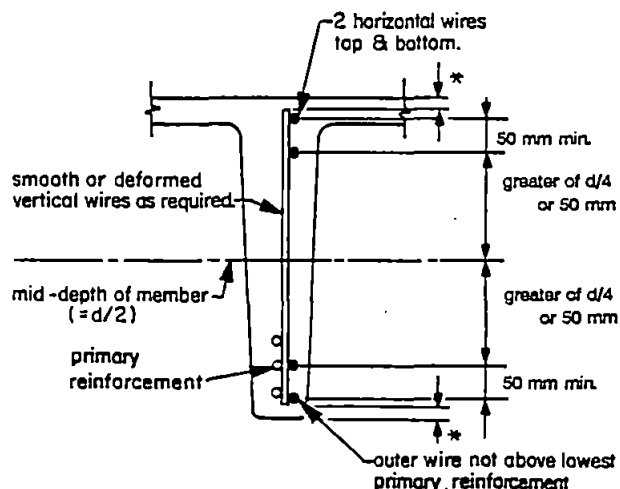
Anclajes de estribos U de malla de alambre liso electrosoldado en la zona de compresión.
